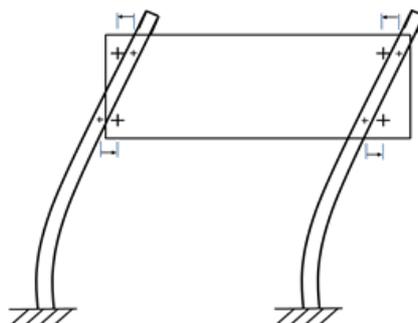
Schema di calcolo nel caso di 4 connettori (deformata corrispondente allo stato limite considerato)
